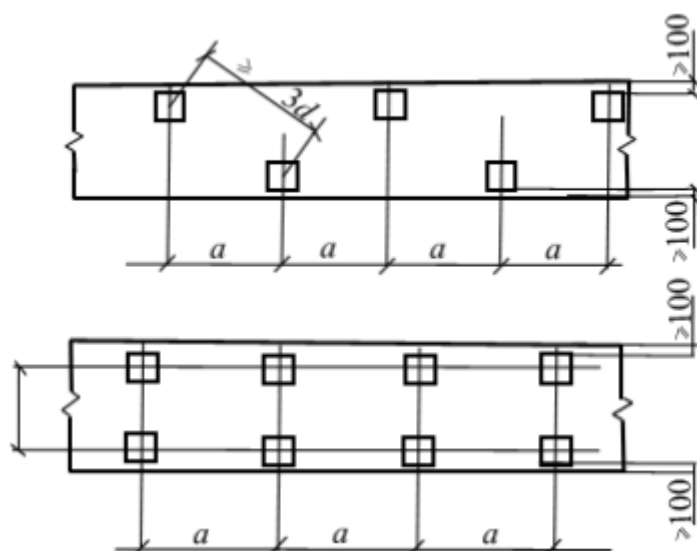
Расположения свай в рядовом фундаменте
